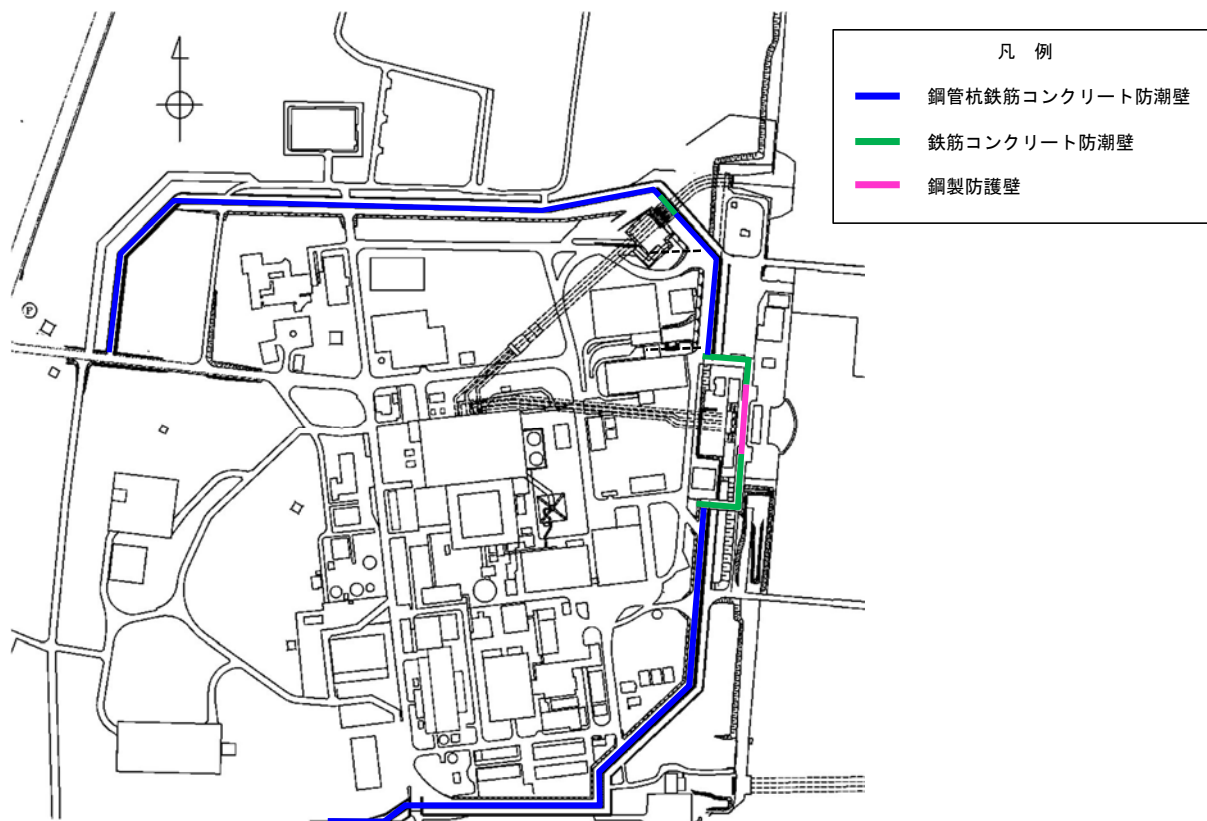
鋼管杭鉄筋コンクリート防潮壁の位置図
